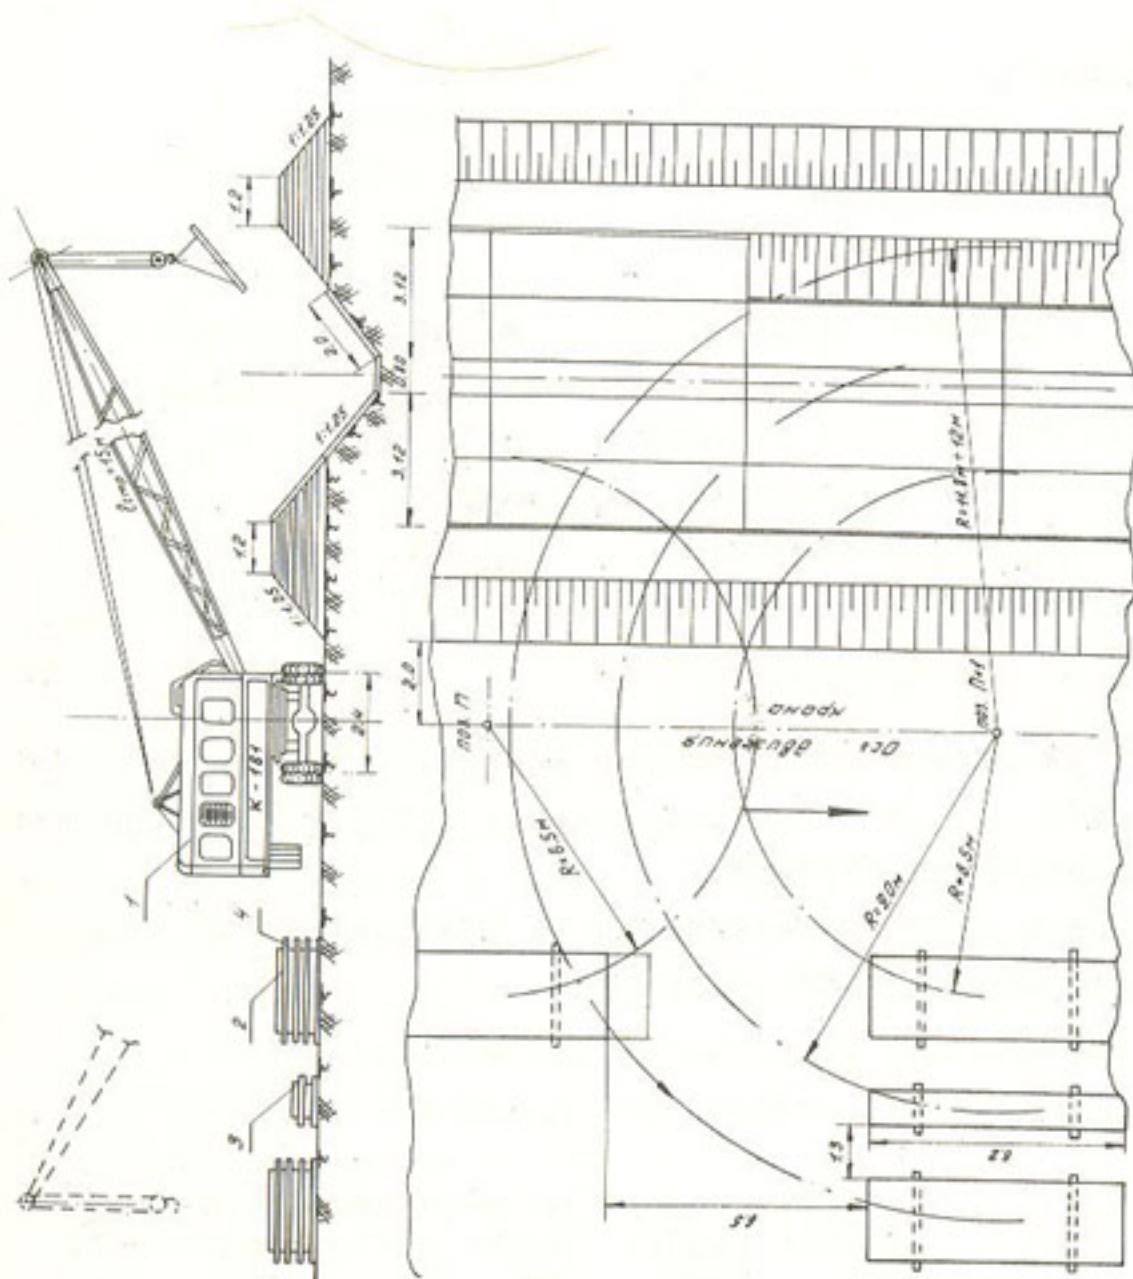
Рис. II. Схема монтажа сборной обшивки из железобетонных плит краном К-16I: 1-кран на специальной масси грузоподъемностью 16 т; 2-железобетонная плита размером 6,2x2,0x0,06; 3-железобетонная плита размером 6,2x0,8x0,06; 4-деревянная прокладка размером 40x40 мм
